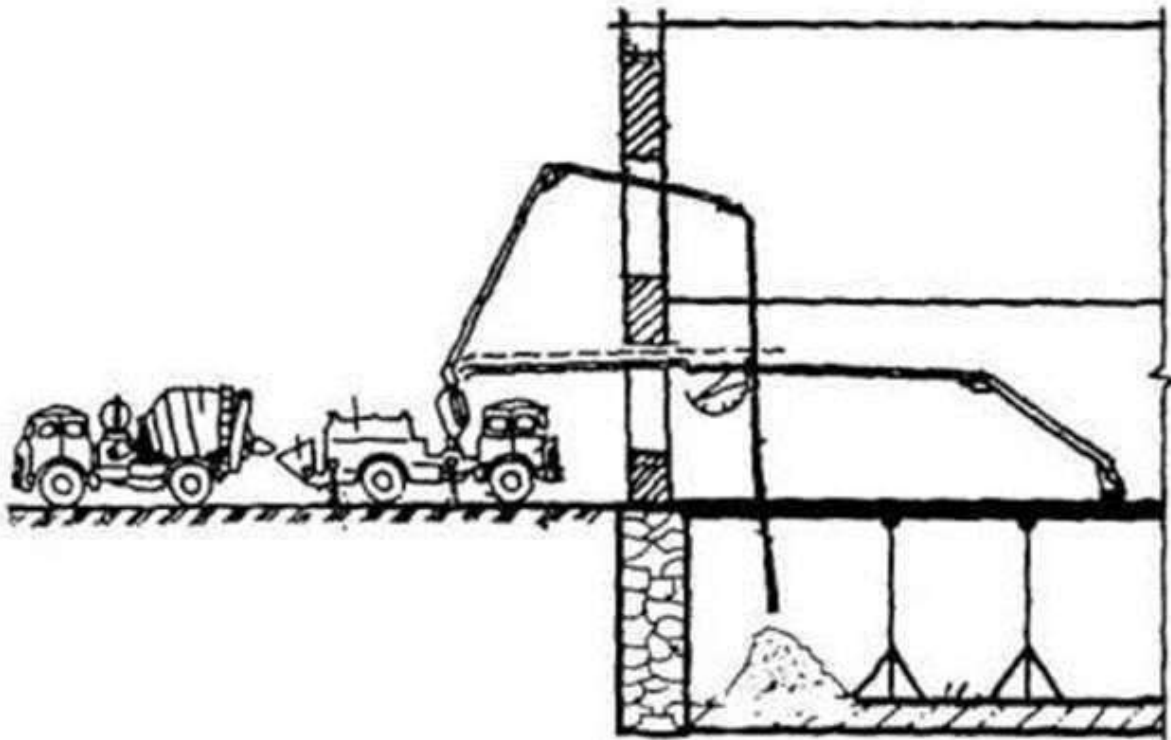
Подача бетона через балконные проемы автобетононасосами при строительстве фундаментной плитки и перекрытий
